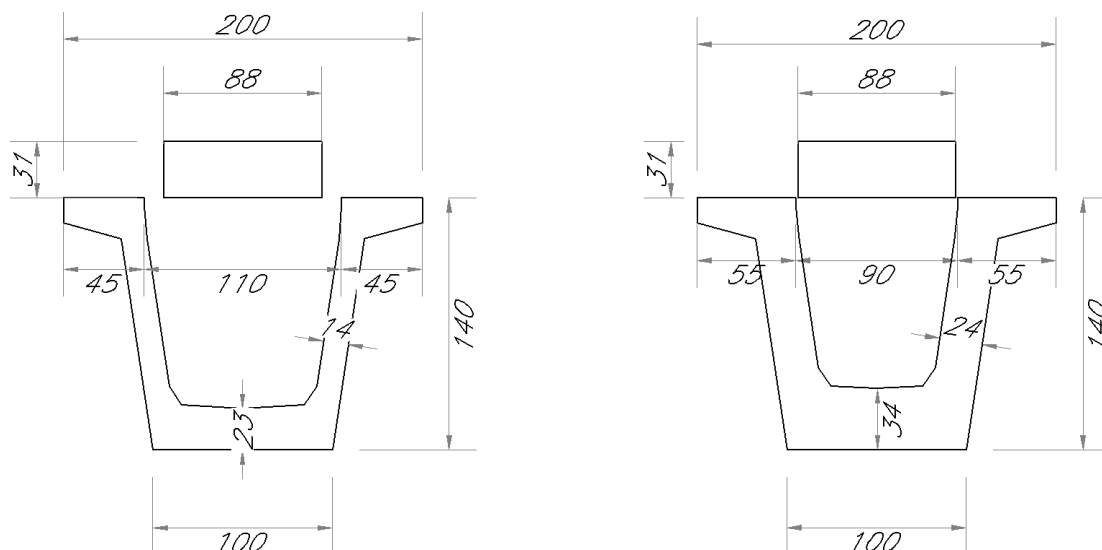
Sezioni in Fase 3 (cassoncino con soletta omogeneizzata a l.t.): sezione corrente e sezione di transizione - sezione di testata
